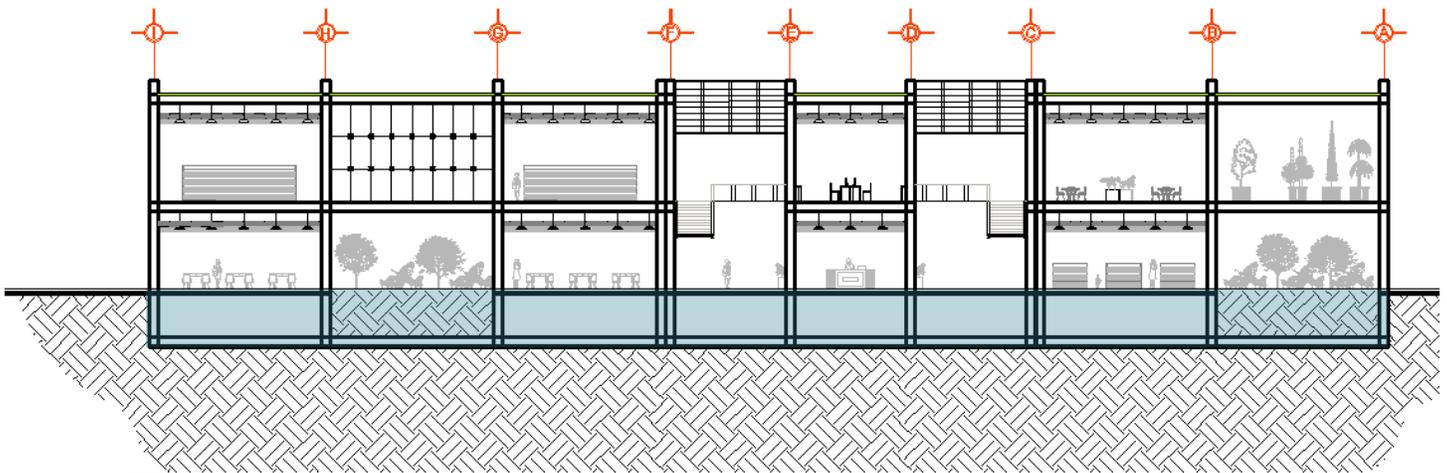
Modelo virtual de la Biblioteca Río Guadalupe, fachada norte
